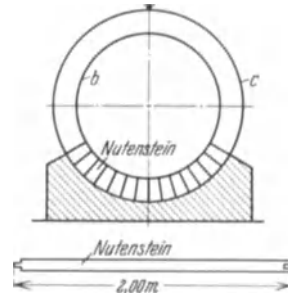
Baustellenrohr aus Eisenbetondauben (Nutensteinen). (E. W. Gutenbühl: Beton u. Eisen 1927.)
